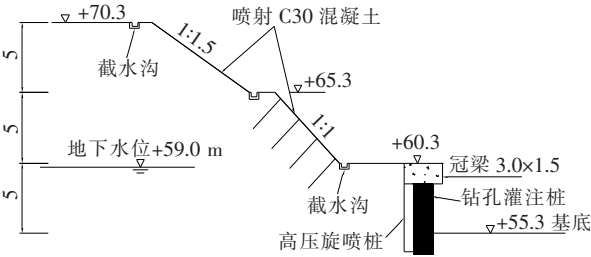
钻孔灌注桩支护+高压旋喷桩止水帷幕立面图(单位:m)
